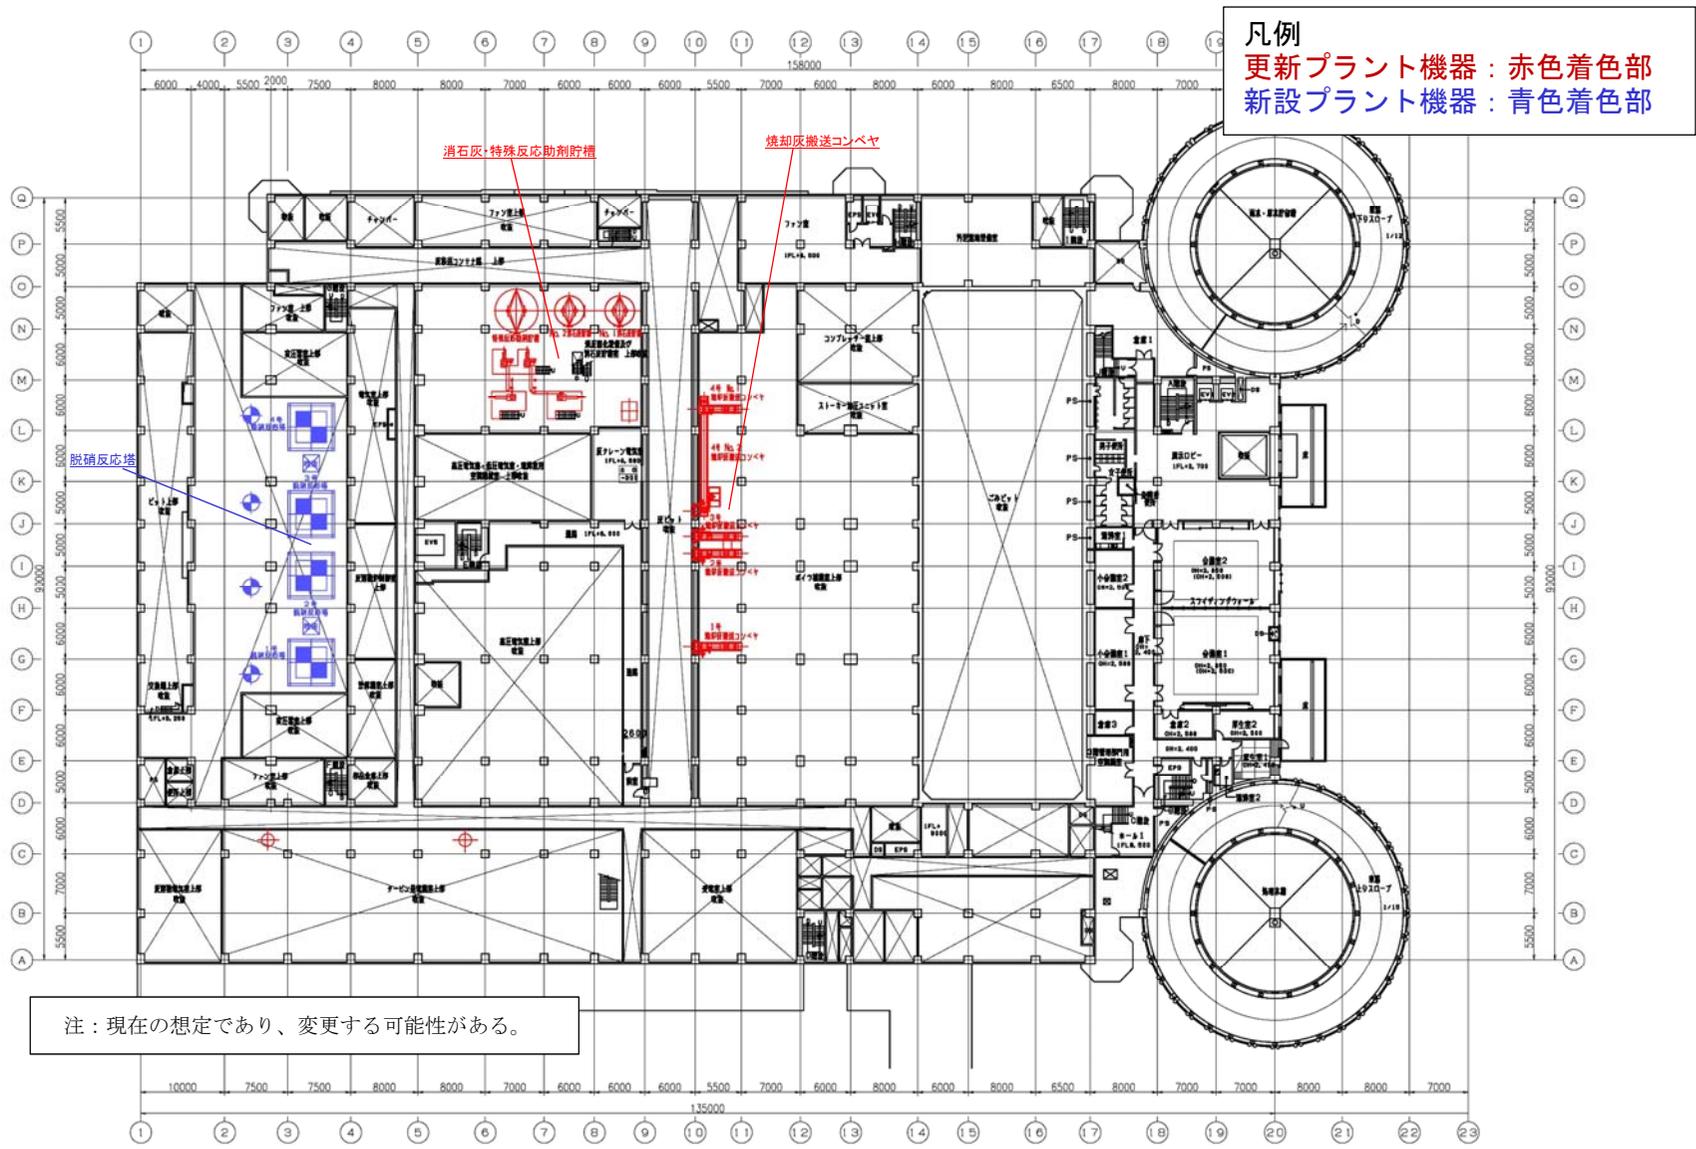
(3) 設備機器の更新箇所 (3階平面図)
